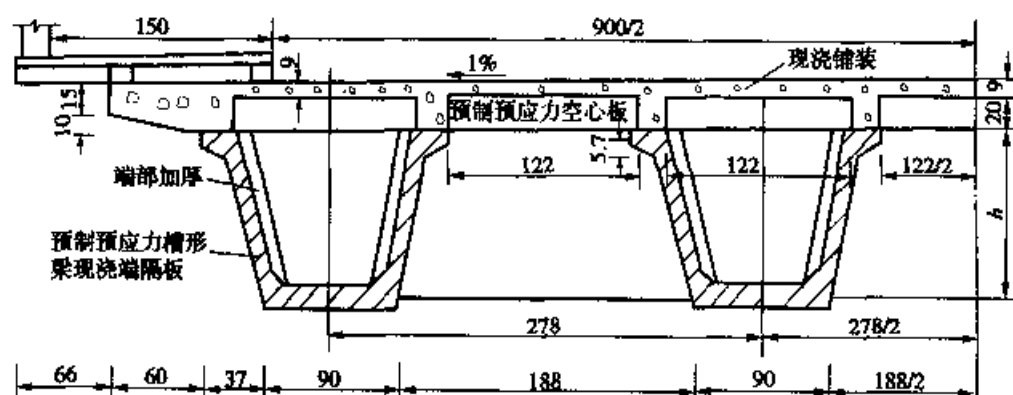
预应力混凝土箱形组合梁桥(尺寸单位:cm)
